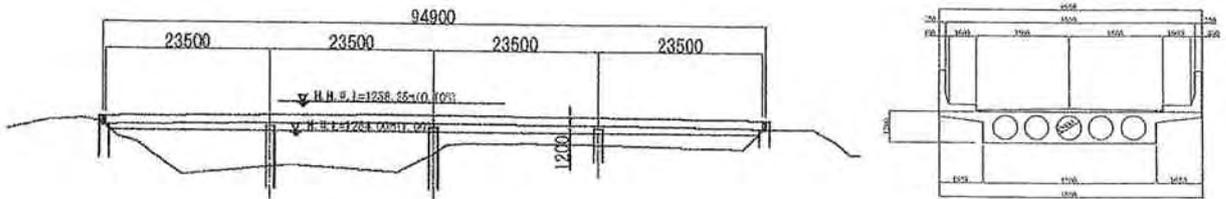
Plan du Pont dalles évidées continues en béton précontraint (longueur de travée : 23,5 m)
